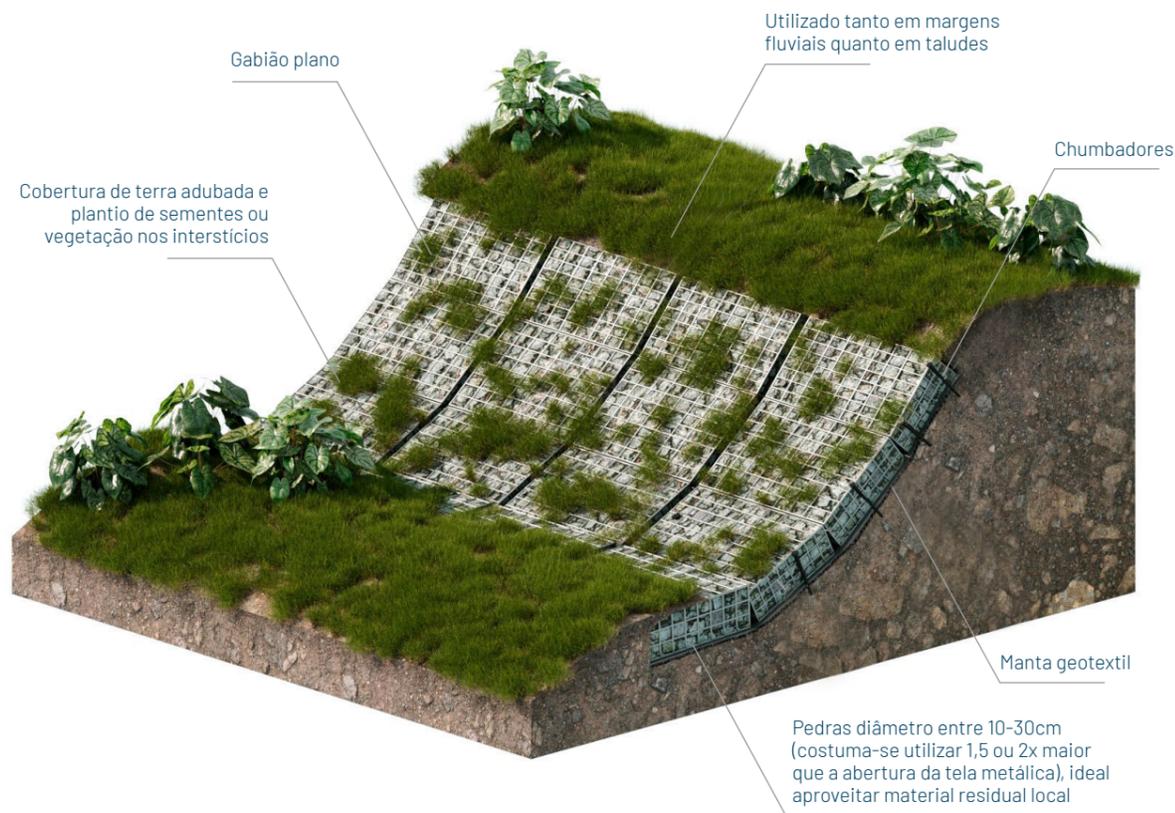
Gabiões planos (Fonte: Guajava. 2023).
